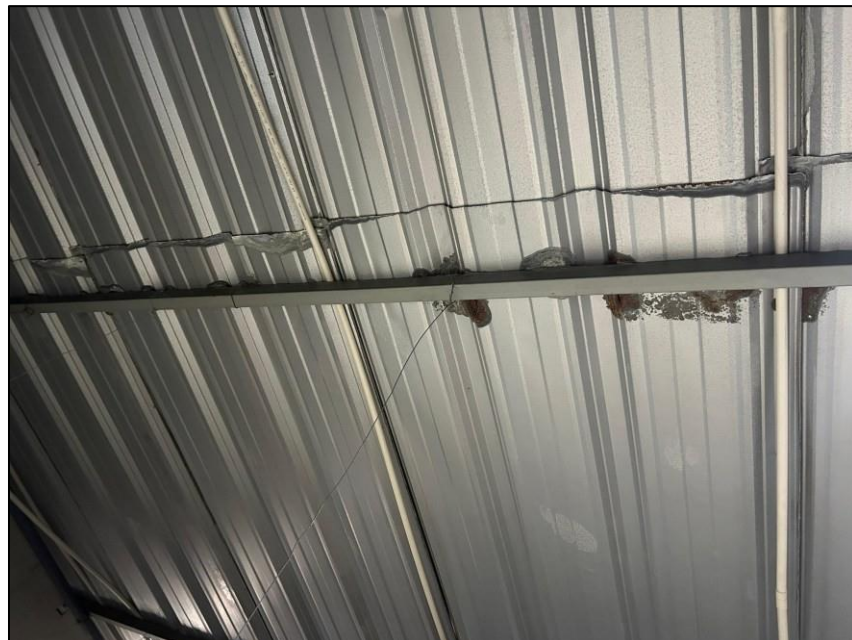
Se muestra el avance del daño en la cobertura liviana metálica tipo TR4 y la viga metálica de soporte.
